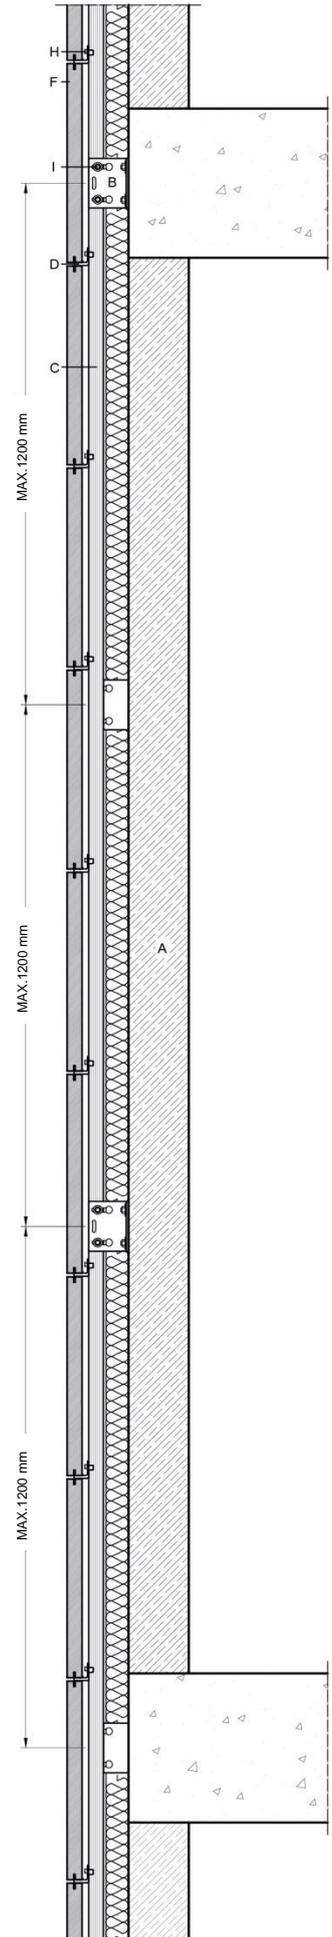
DETALLE DE LAS JUNTAS ENTRE PERFILES HORIZONTAL Y PERFILES VERTICALES
